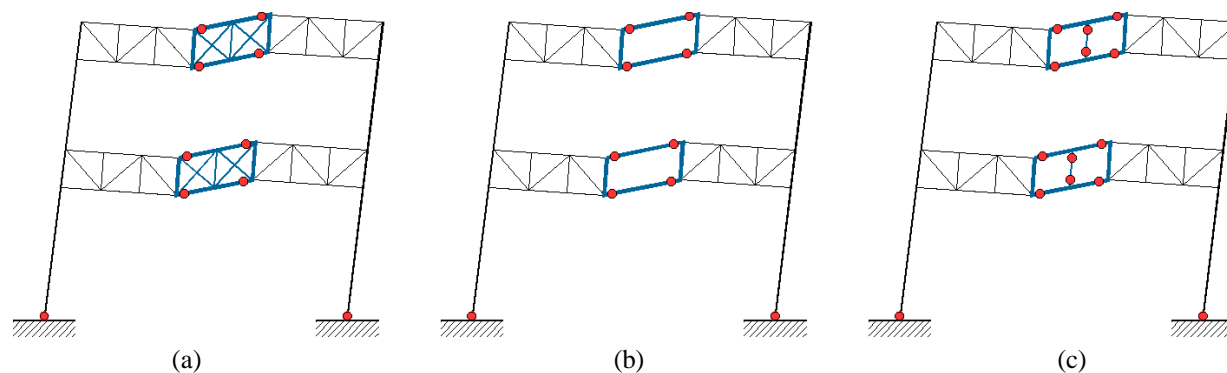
Mecanismo de deformación plástica para casos típicos de marcos con vigas de alma abierta dúctiles especiales
